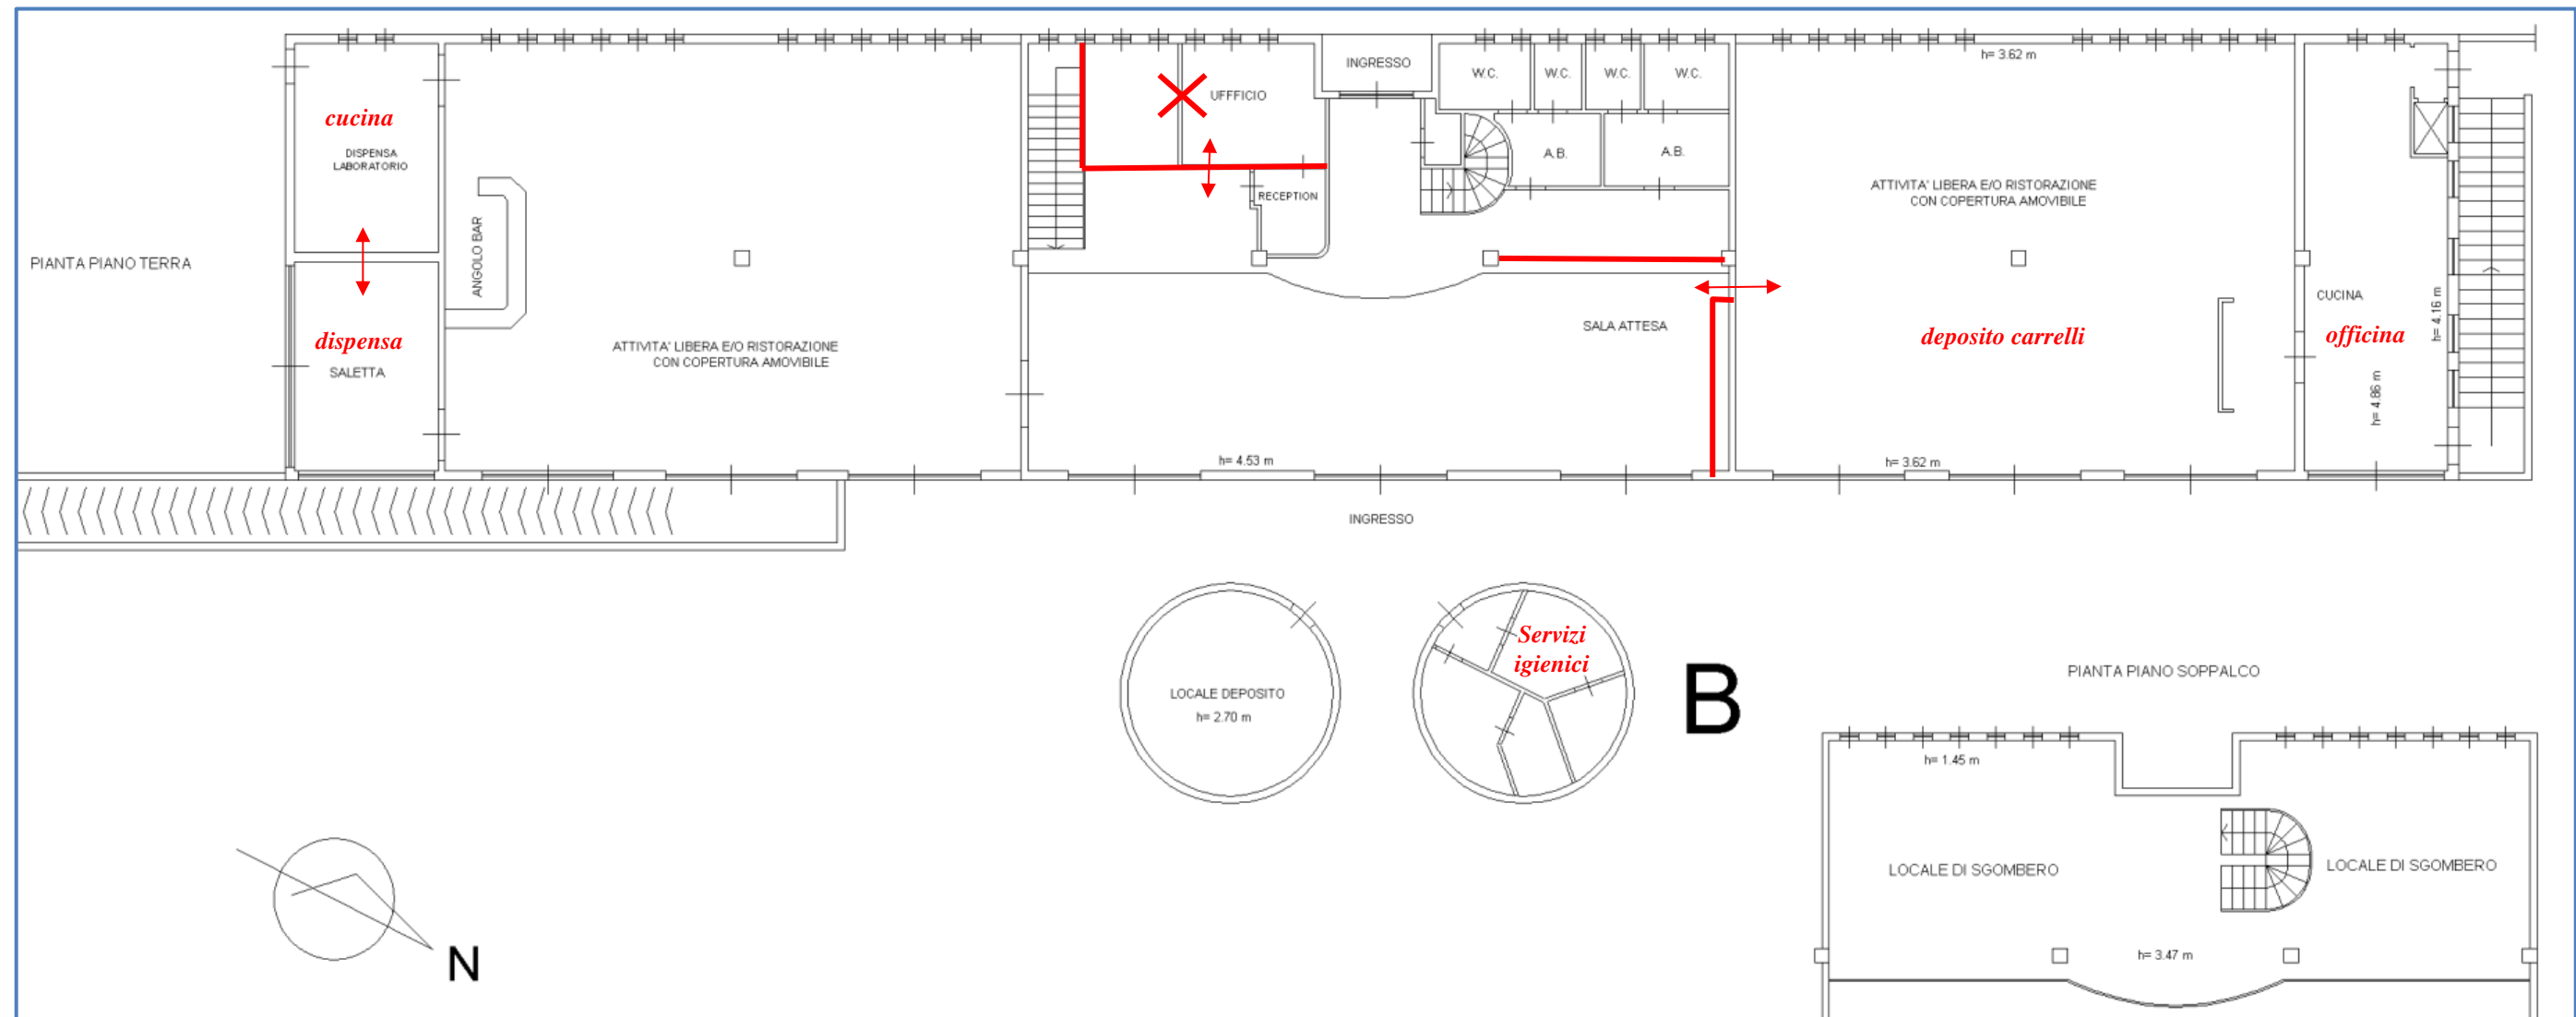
estratto della planimetria catastale particella FG.16 M.758 S.1
